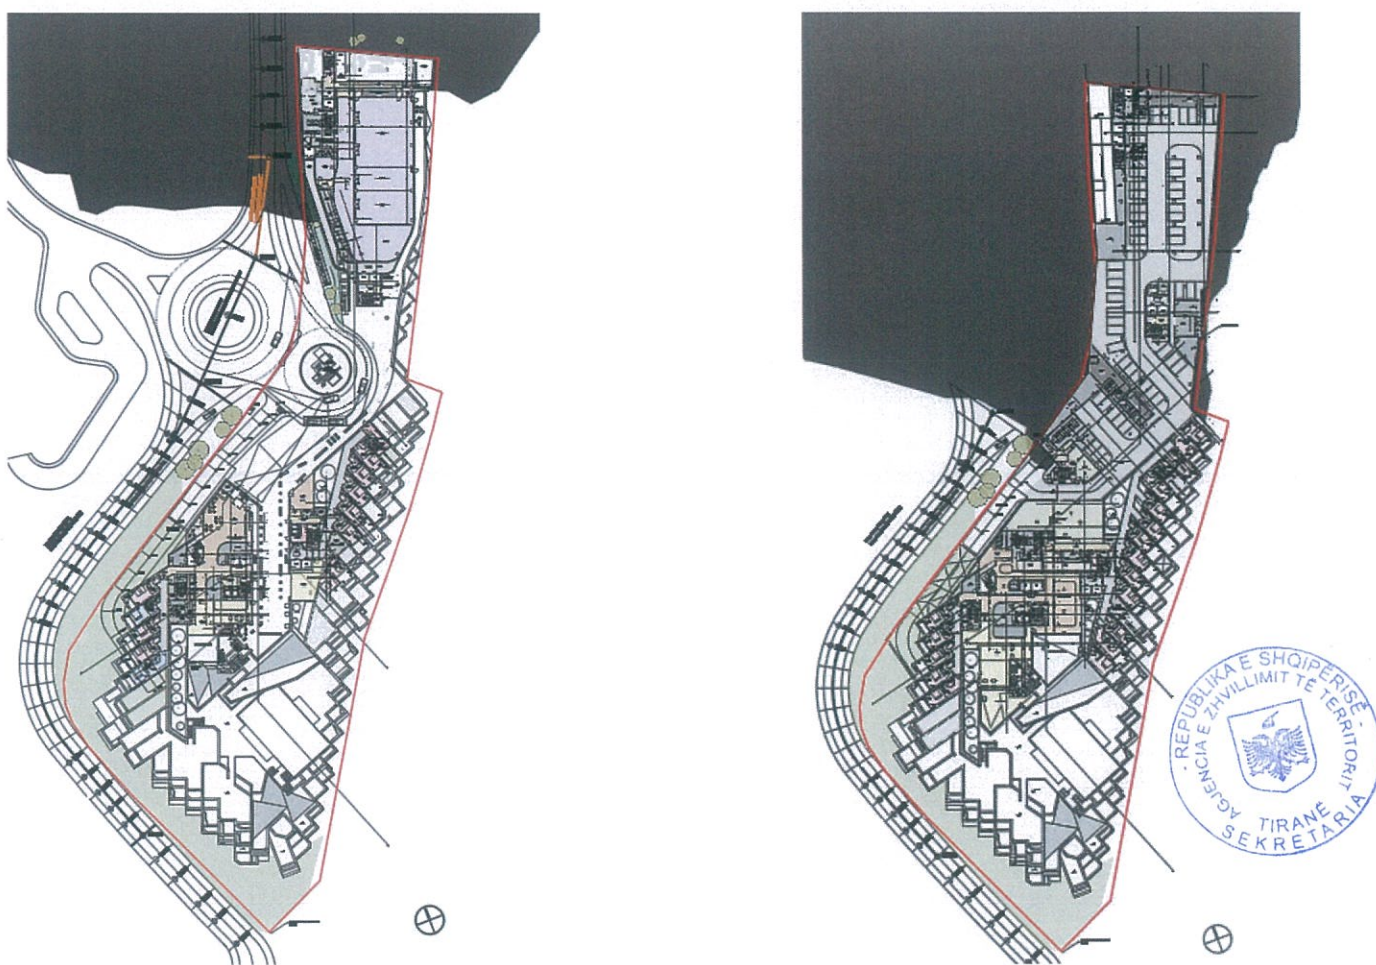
Planimetria e katit përdhe (majtas) dhe katit -1 (djathtas)
